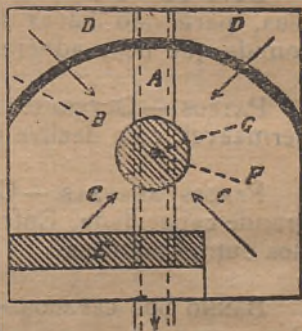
DISPOSIÇÃO DO PAVIMENTO DE UM CURRAL
